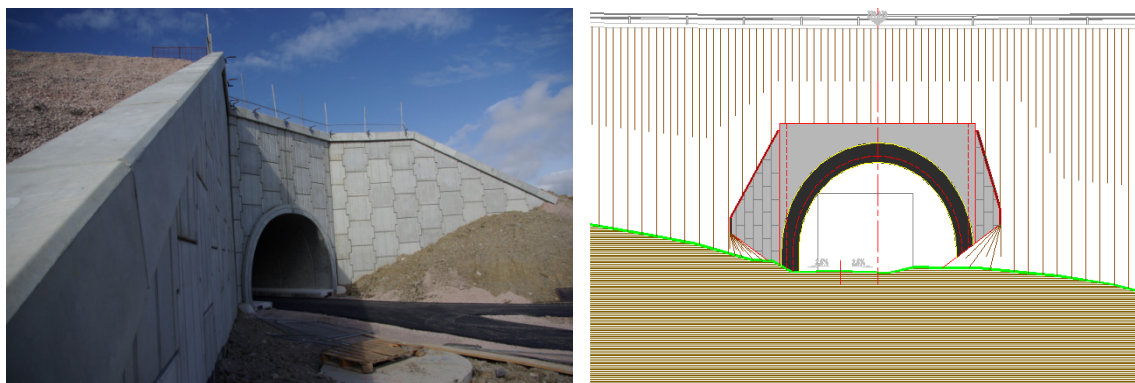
Obras de entrada e de saída por emboquilhamentos pré-fabricados e de betão armado (<http://www.reinforcedearth.co.uk>) (COBA *et al.*, 2008)
